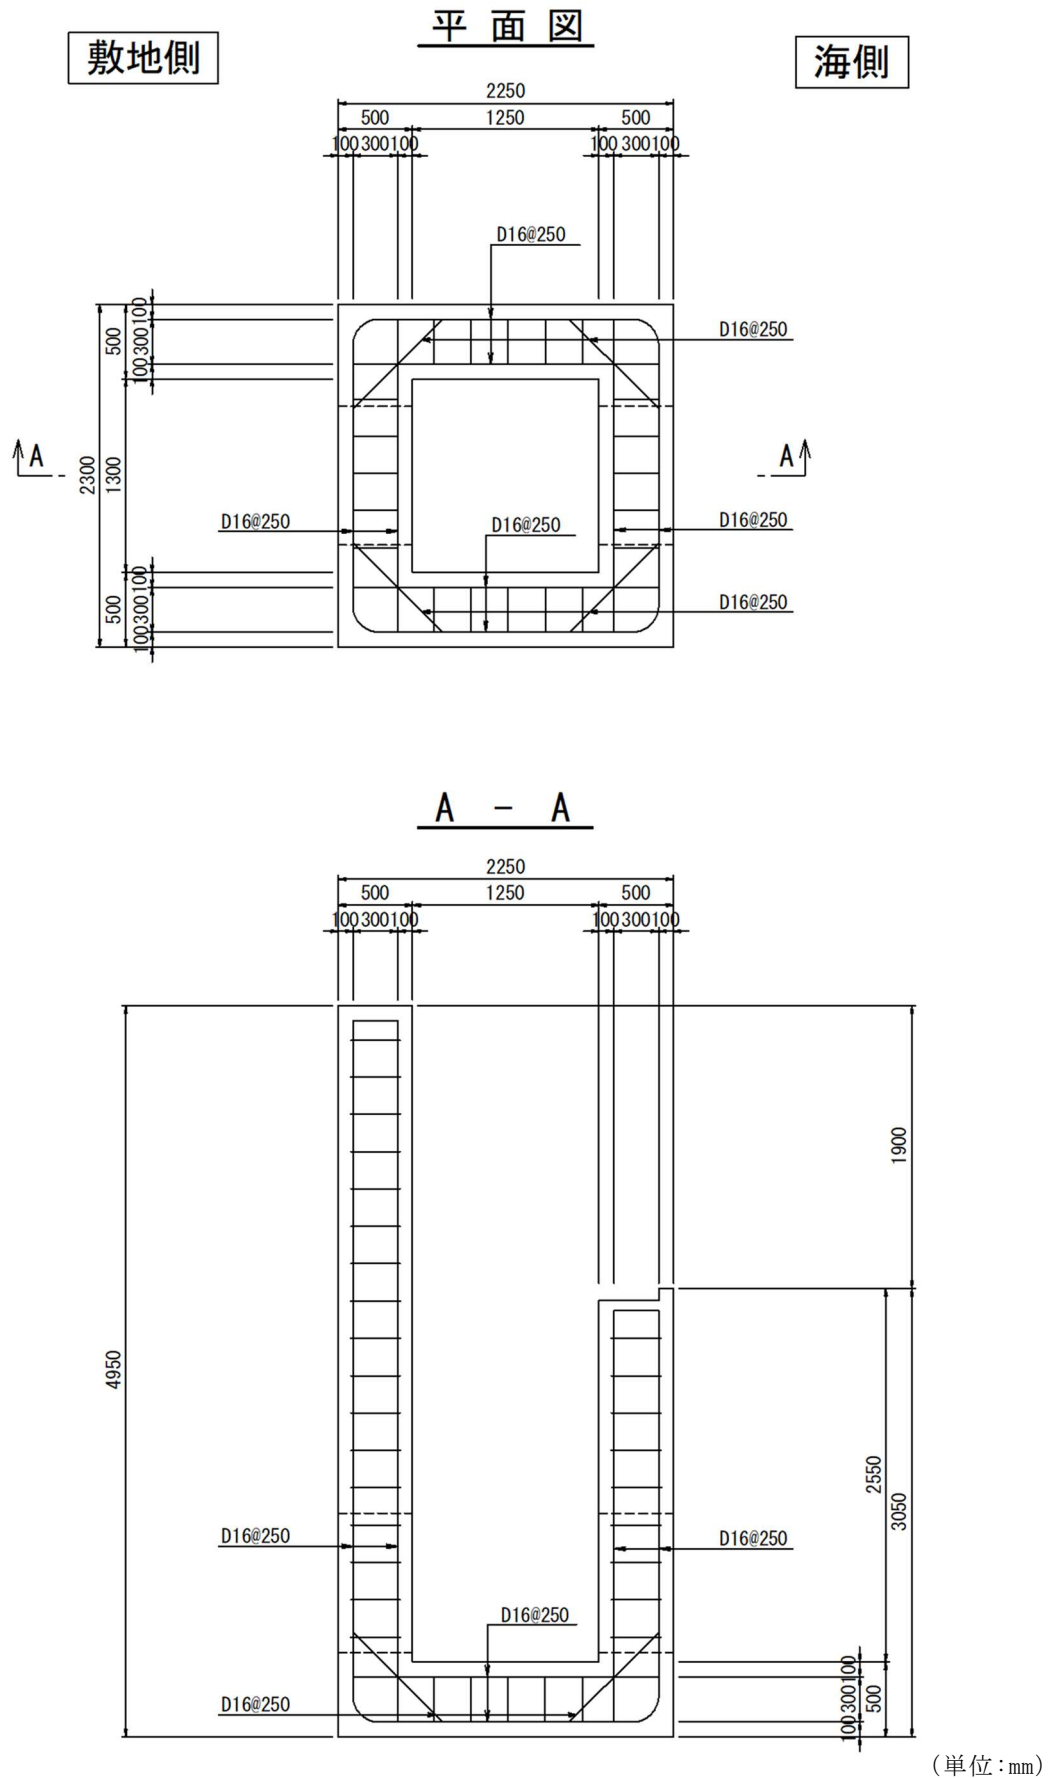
(8) 概略配筋図 (集水柵 (屋外排水路逆止弁①))
